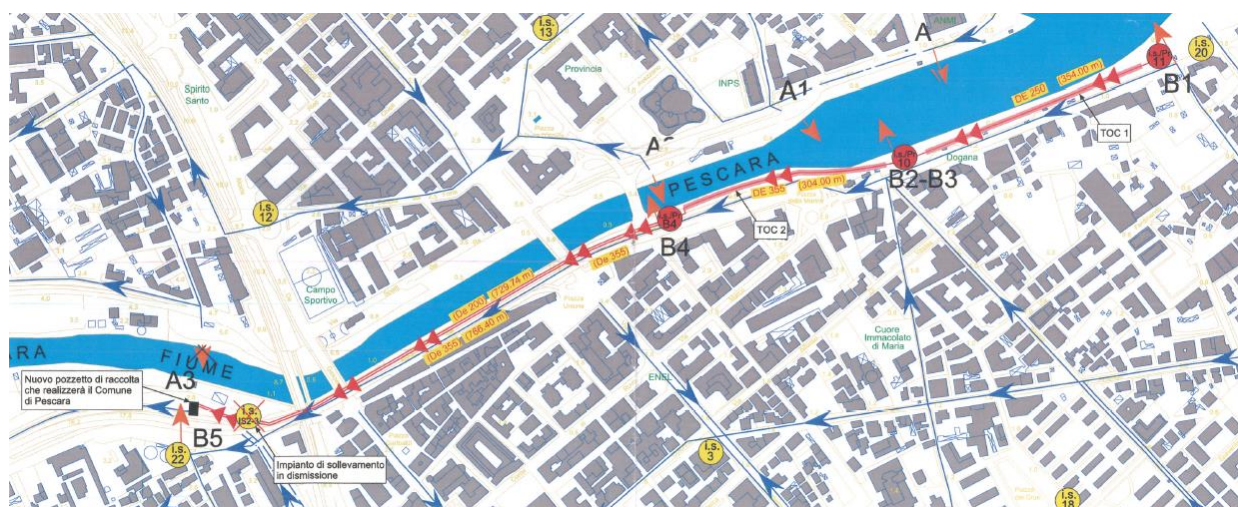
Planimetria della rete fognaria di Pescara secondo il Progetto Esecutivo DK15 dettaglio sponda destra (zona 2)
